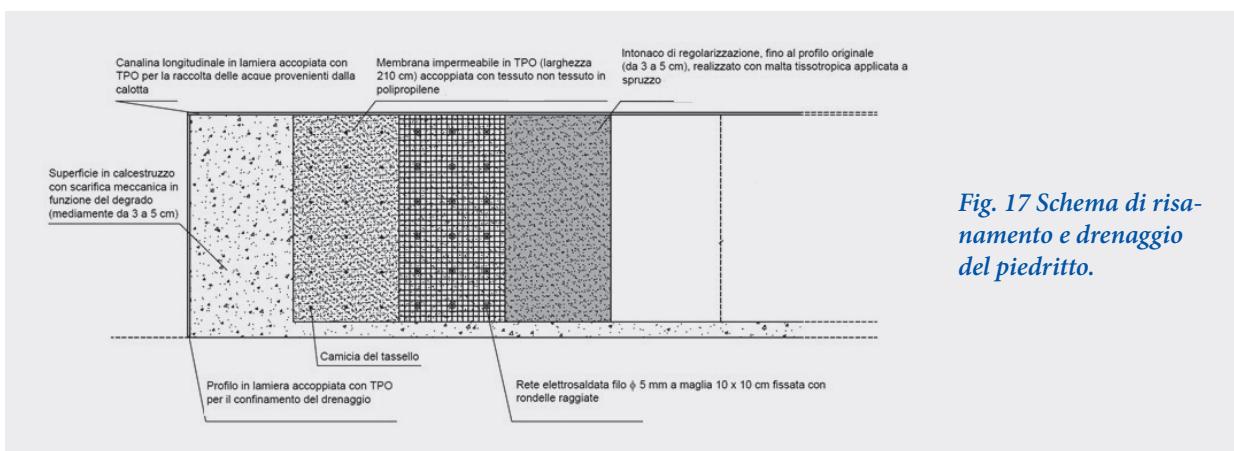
Schema di risanamento e drenaggio del piedritto.
